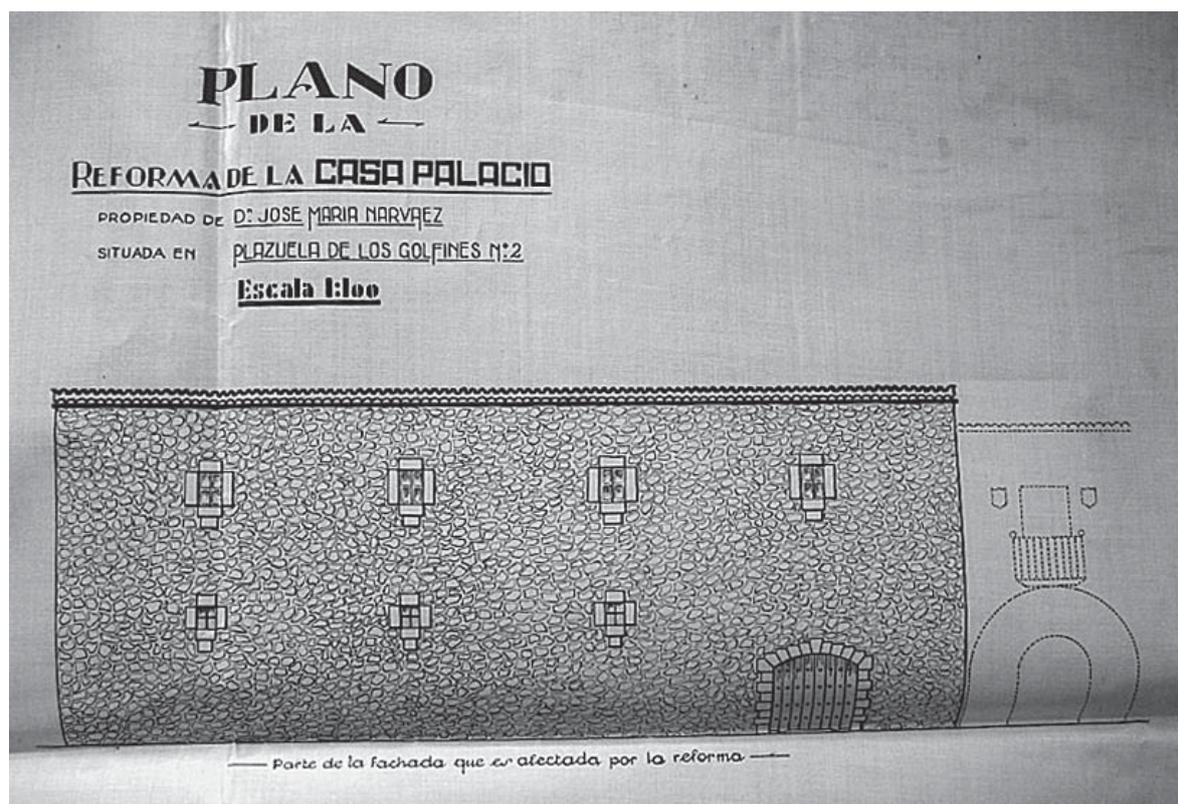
Alzado de la fachada reformada, atribuido a Ángel Pérez. A.H.M.C.C.
